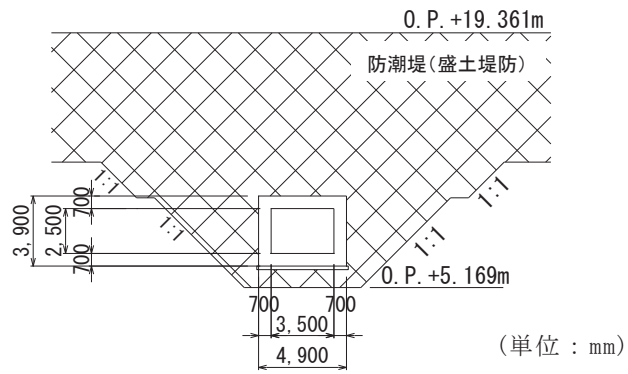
(2) 北側排水路の断面図 (B-B 断面)
